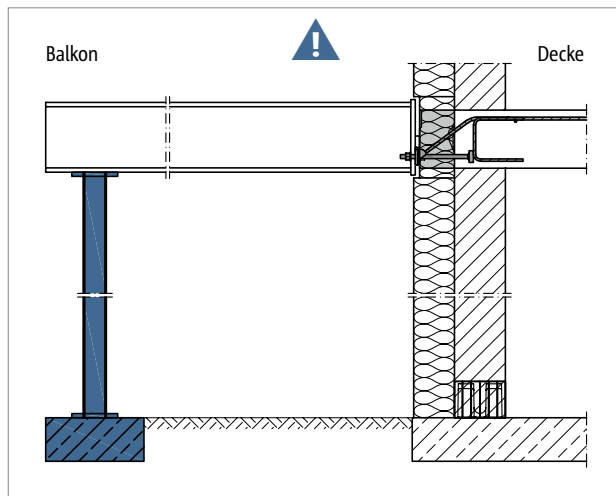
Schöck Isokorb® XT Typ SQP: Stützung durchgängig erforderlich
